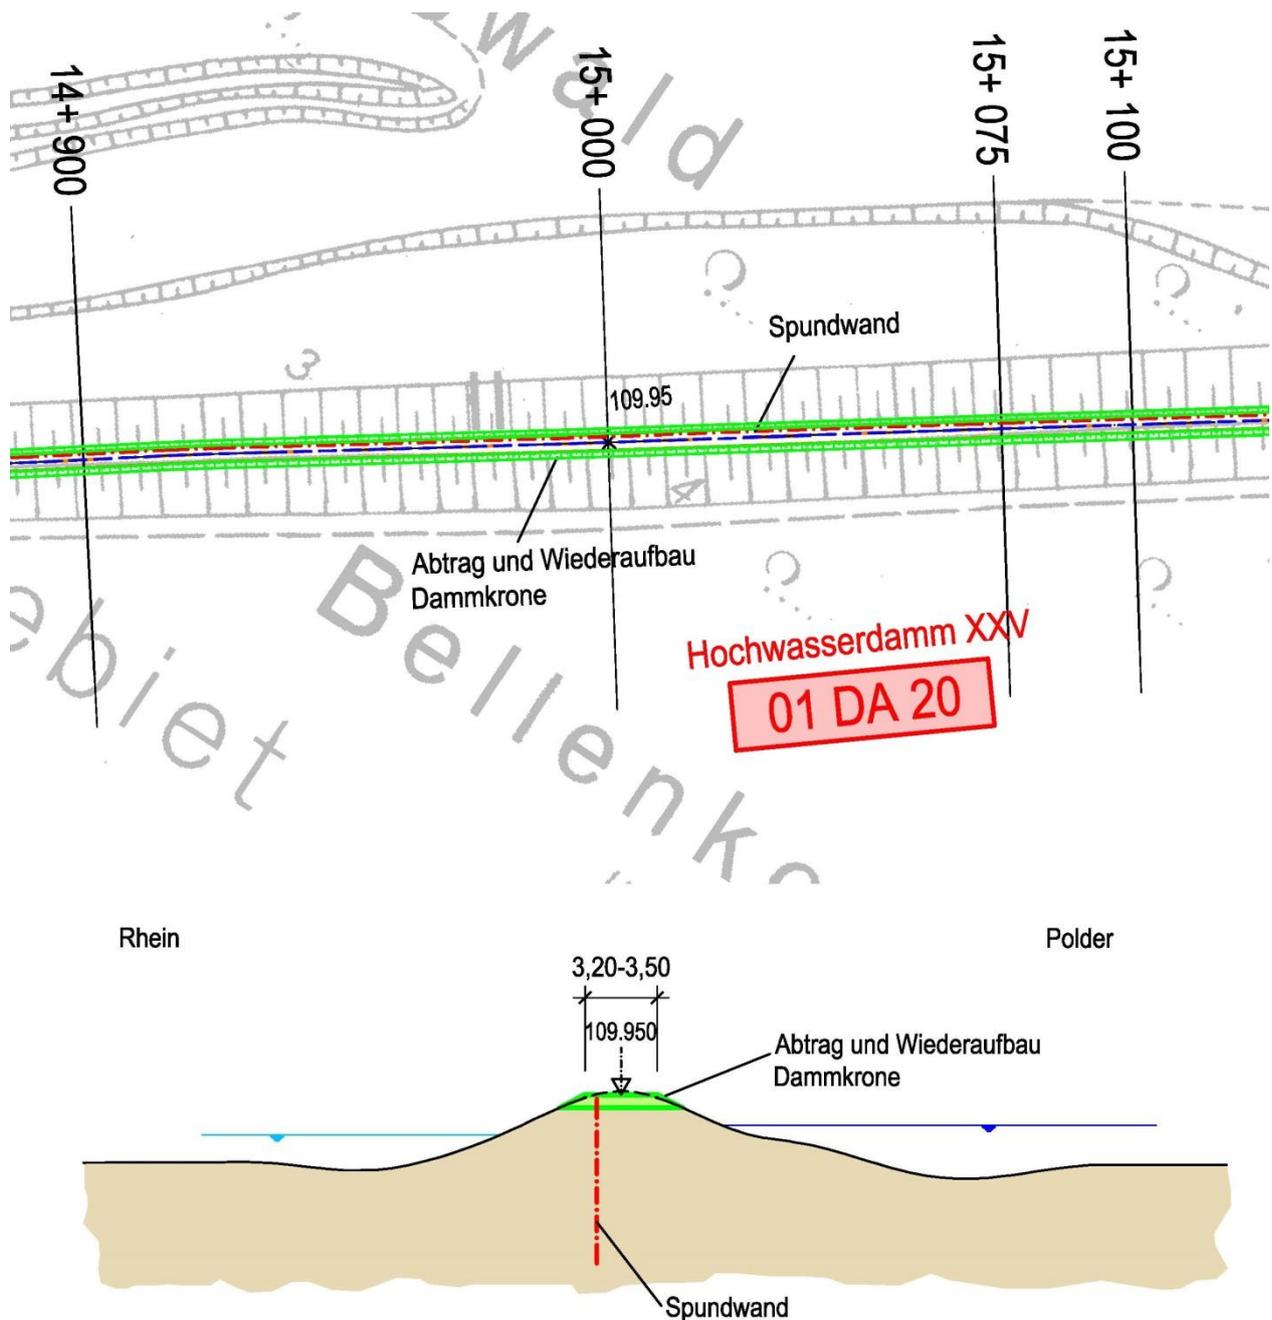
Lageplan und Querschnitt der Alternative 2
